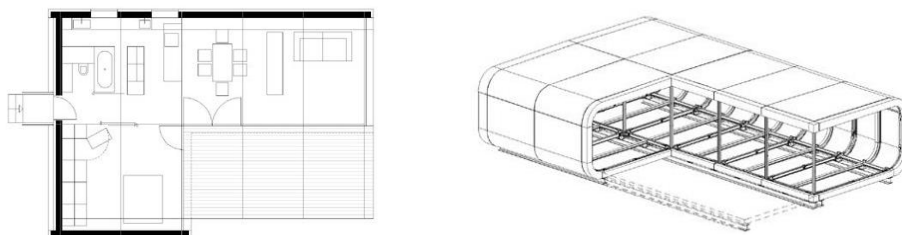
Nomadhome*, planta e axonometria da estrutura.
